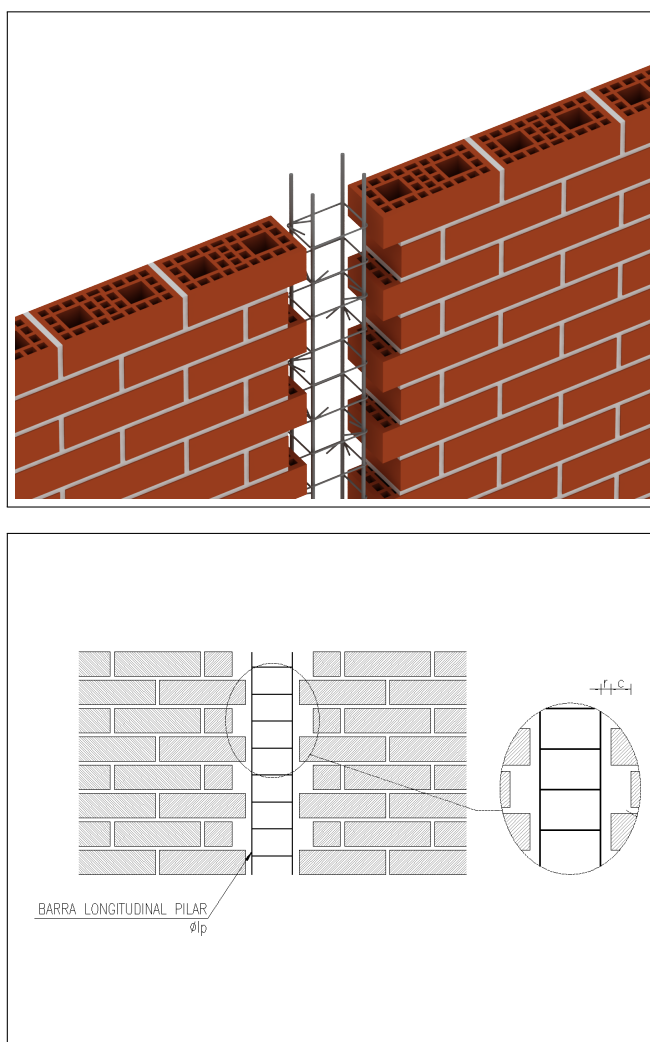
Detalle de la unión endentada entre el paño de albañilería y un pilar de confinamiento intermedio.
